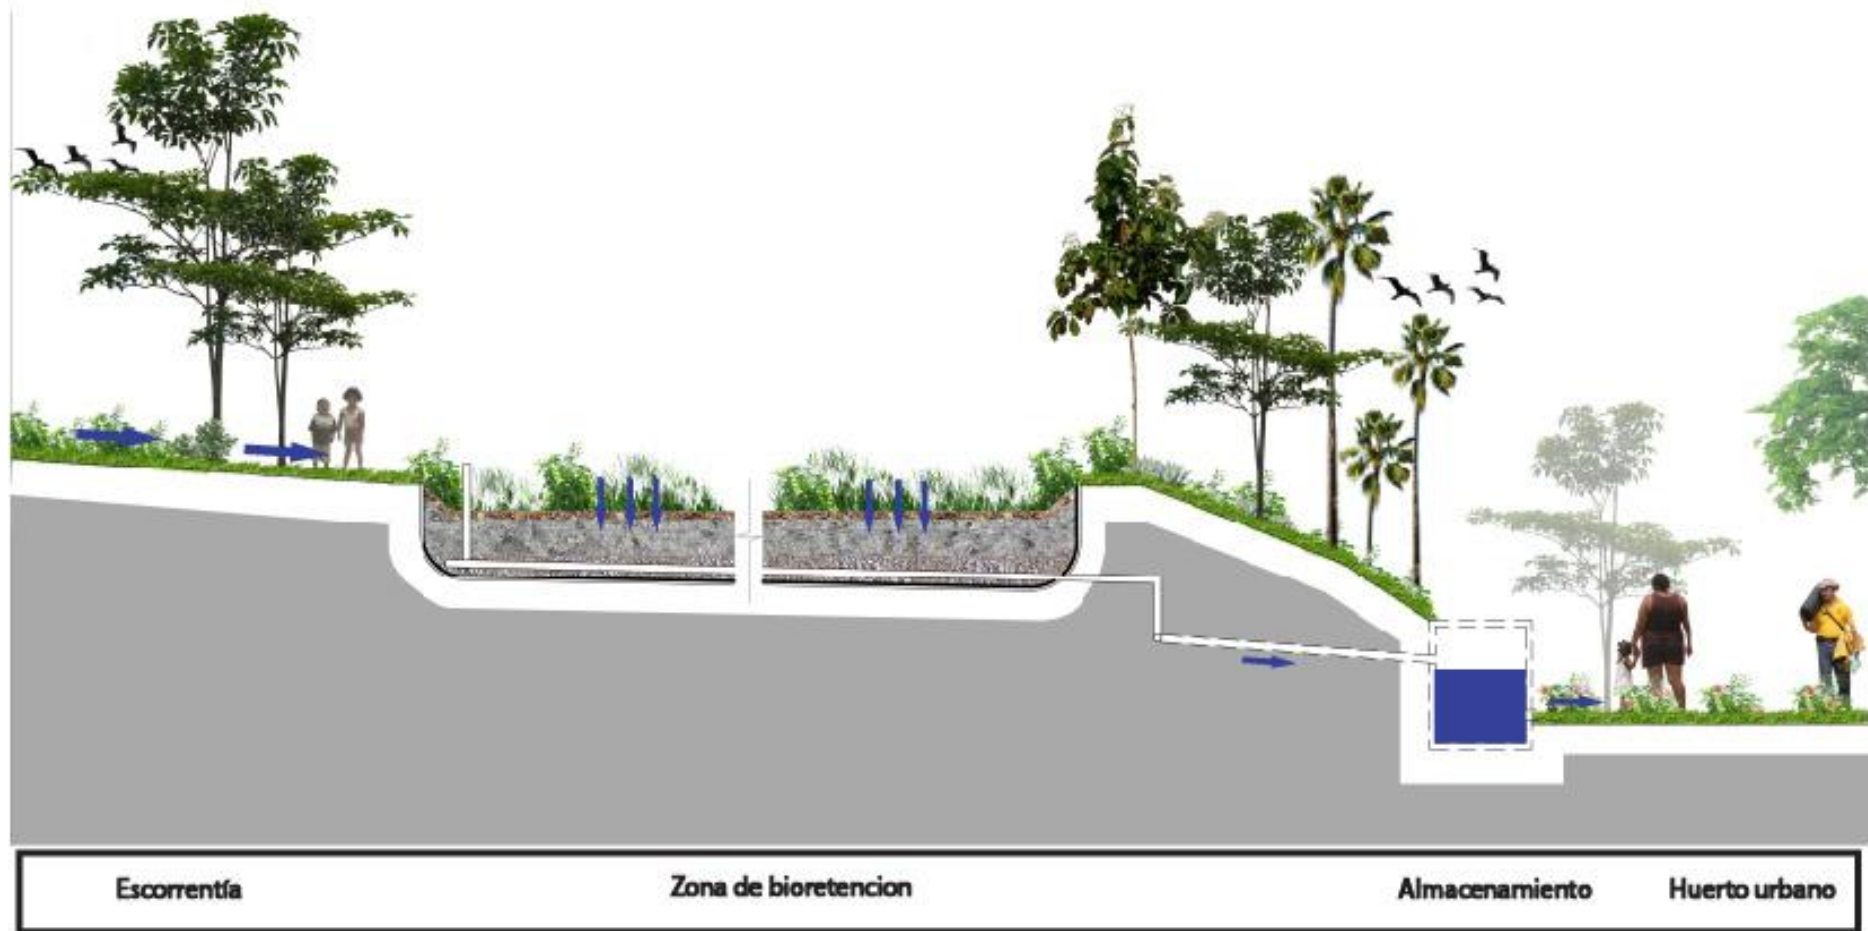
Sección longitudinal zonas de bioretención. Fuente: Elaboración propia
